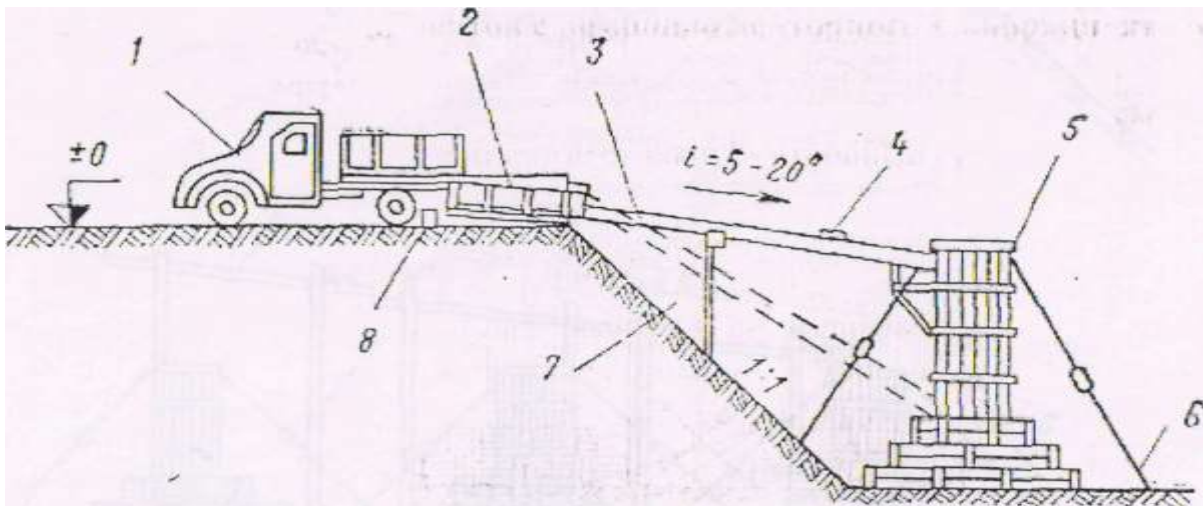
Схема бетонирования фундамента с помощью виброконвейера
